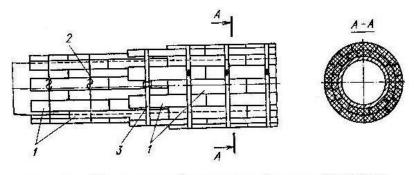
Изоляция трубопроводов жесткими сегментами: 1 - сегменты, 2 - кольцо, 3 - бавдаж
